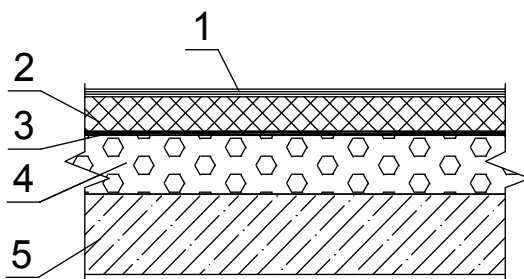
Рекомендуемая конструкция совмещенного утепленного покрытия:
